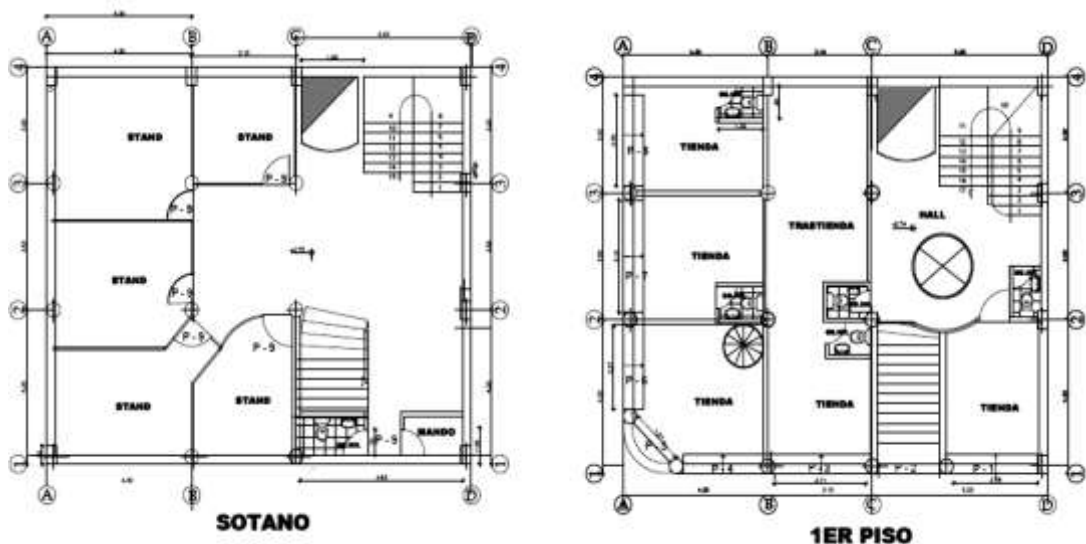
Plano en planta sótano, 1er nivel del edificio comercial-hotel.
